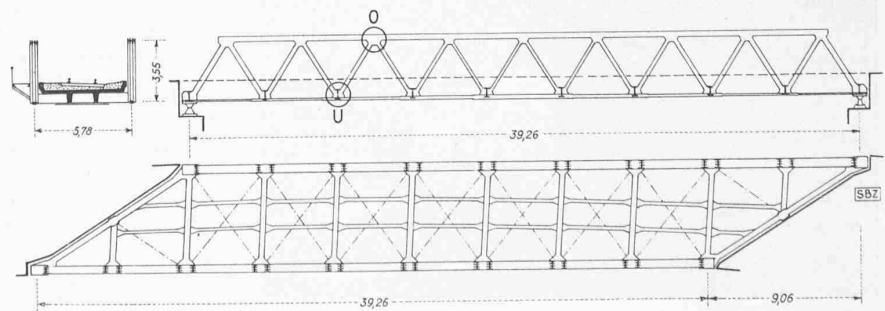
Grundriss, Ansicht und Schnitt der geschweissten Eisenbahnbrücke Joncherolles. — 1 : 400
